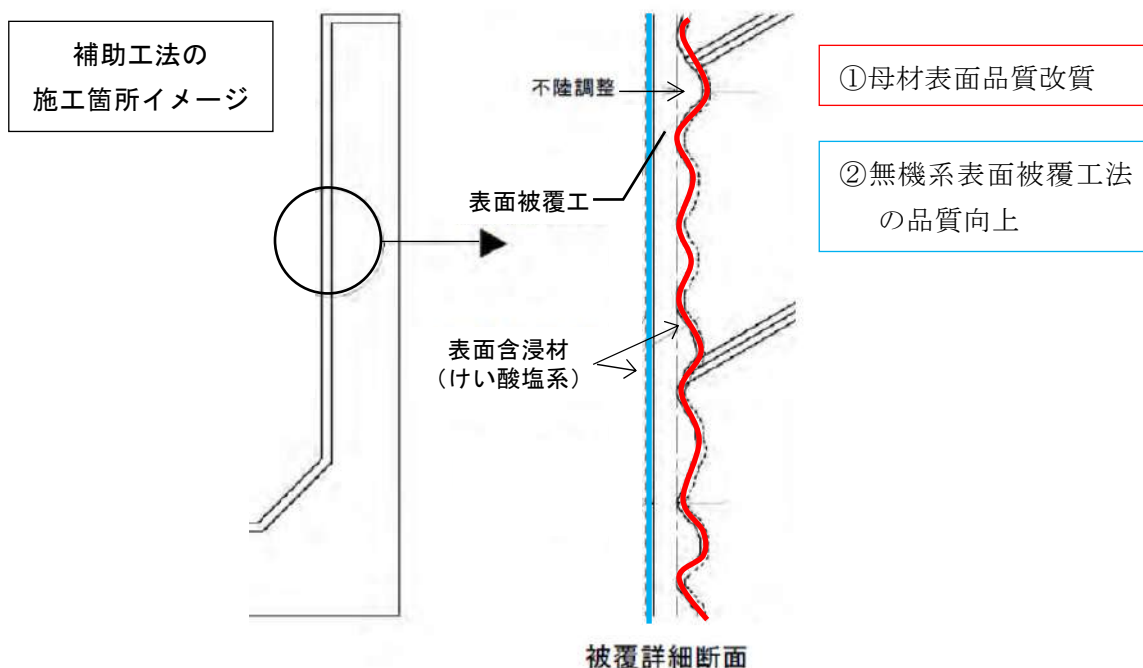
無機系表面被覆工法の補助工法施工箇所イメージ
